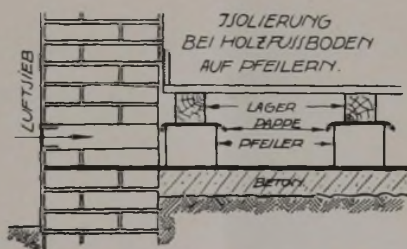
Die Lagerhölzer sind auf Beton- bzw. Mauerpfeiler verlegt und durch Sperrschicht besonders geschützt. Die Entlüftung durch Verbindung mit der feuchtgesättigten Außenluft ist nicht zu empfehlen und hat sich nicht bewährt, weil erfahrungsgemäß das Holz allmählich angegriffen wird und Fußkälte eintritt, die der größere Hohlraum verhindern soll.
